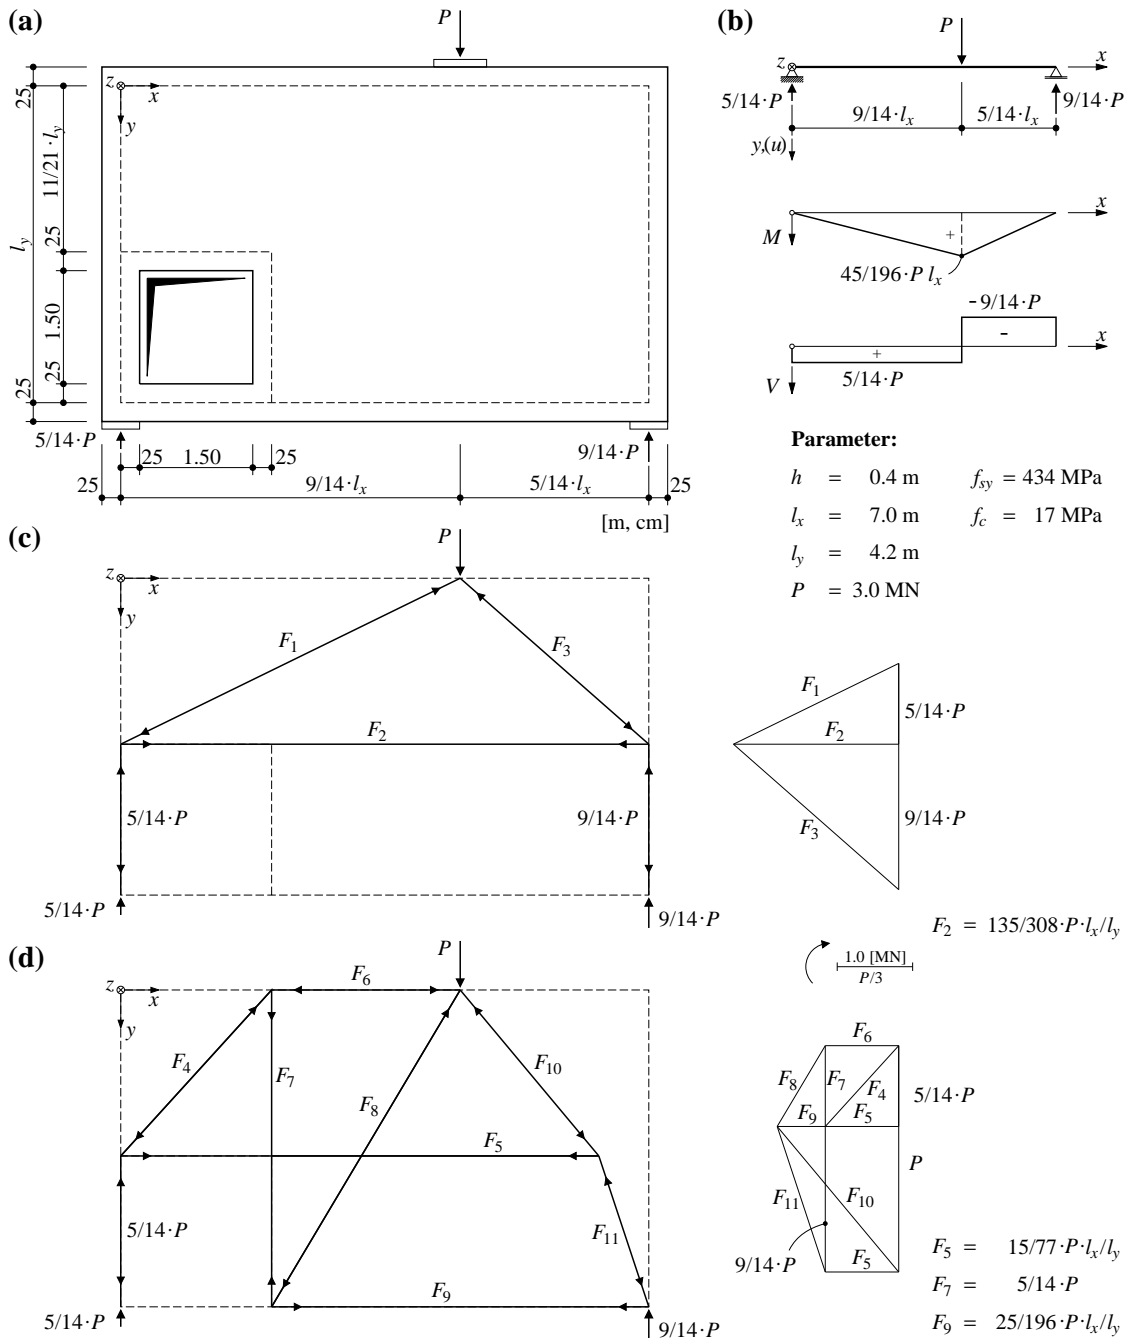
Beispiel Wandartiger Träger mit Öffnung [Schlaich et al. (1987)]: (a), (b) Wandscheibe mit statischem System und Schnittkörperdiagrammen; (c), (d) Fachwerkmodell mit zugehörigem CREMONAplan.
